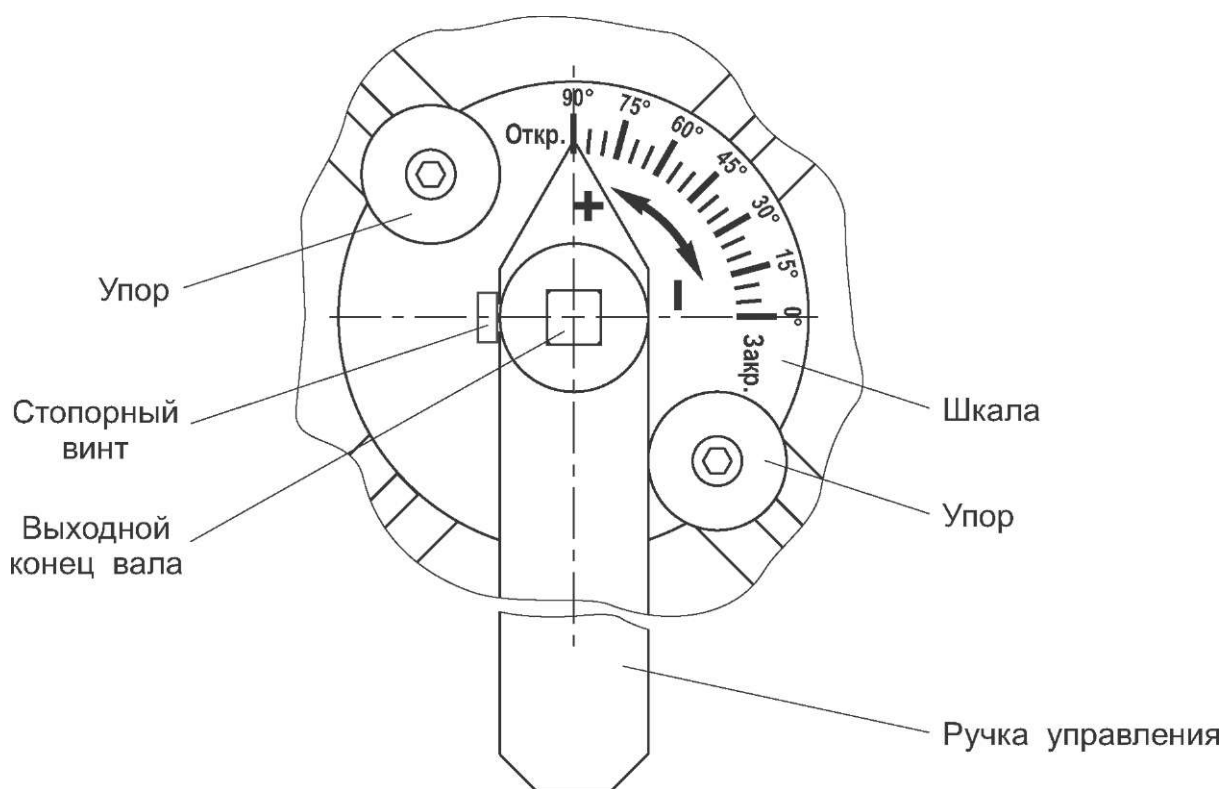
Заслонка регулирующая с ручным управлением (вид сверху)
